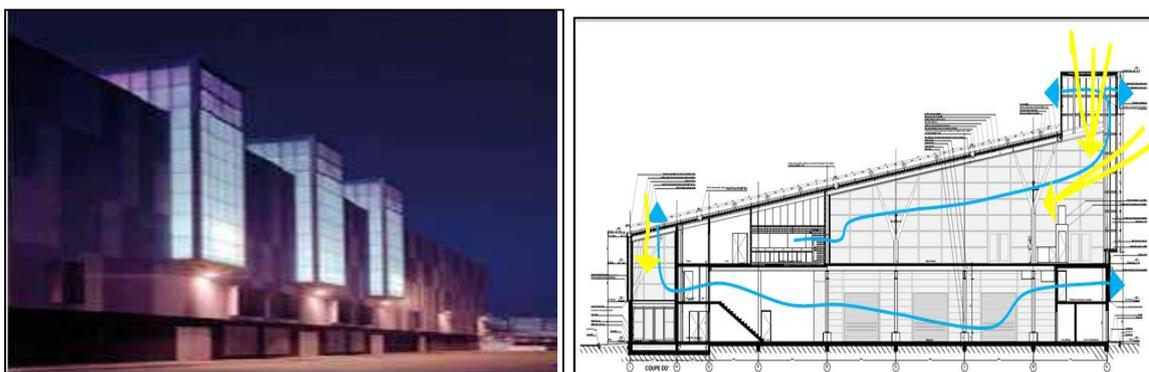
traitement formel de la façade (boîte de lumière) - Figure 104 : Coupe transversale montrant la ventilation et l'éclairage naturel de la gare
